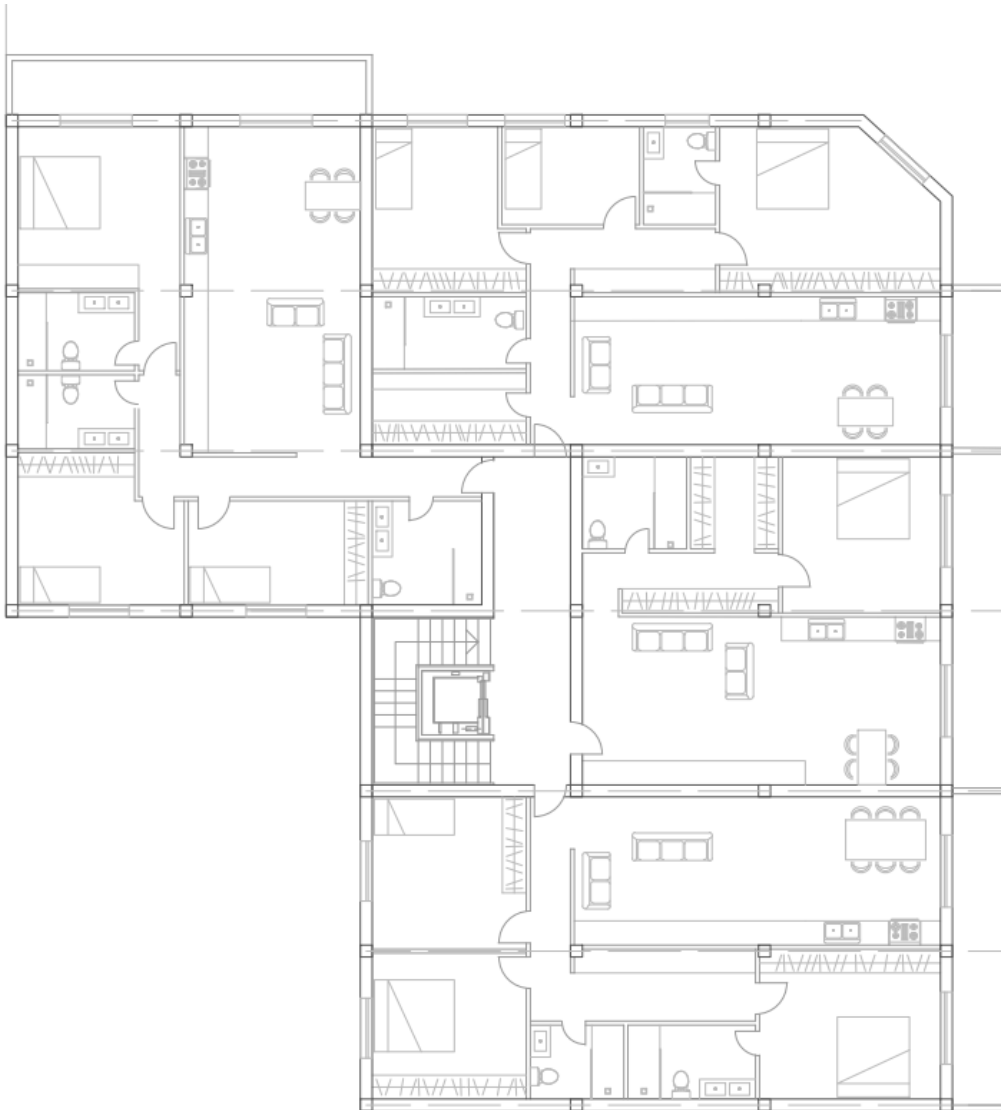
Planta de distribución del edificio tipo con estructura de hormigón armado realizada en AutoCAD.
